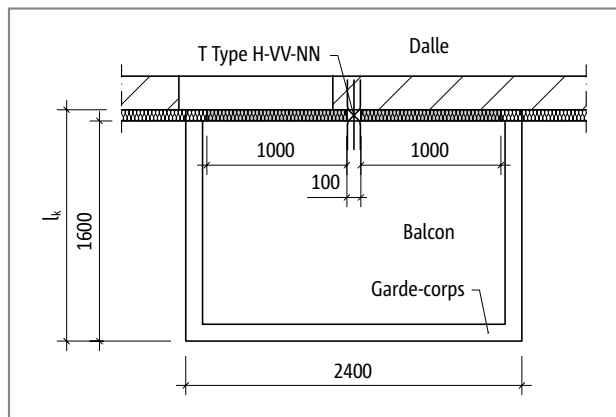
Schöck Isokorb® T type K-E, K-T avec Type T : Système statique, plan de base
